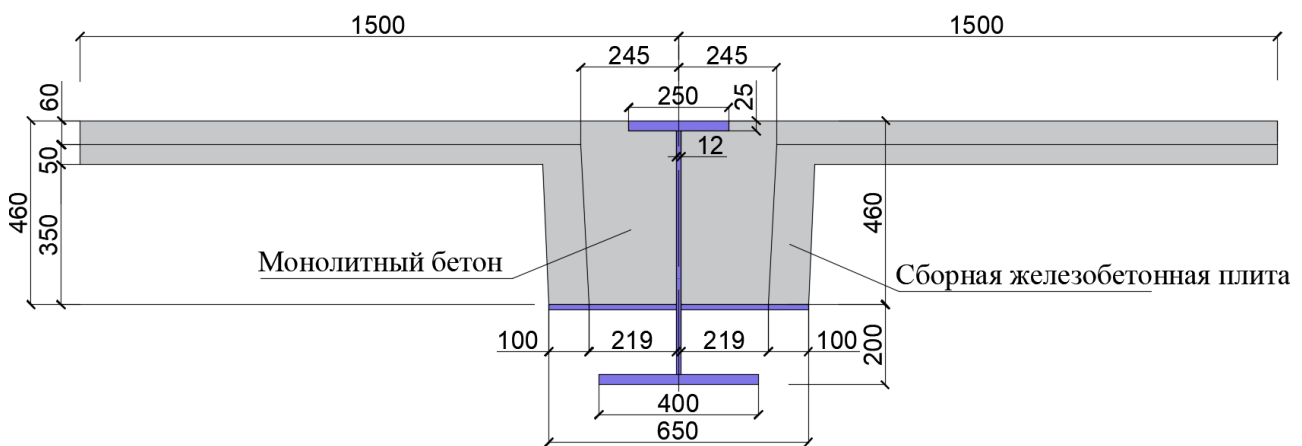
Поперечное сечение сталежелезобетонной балки № 2
